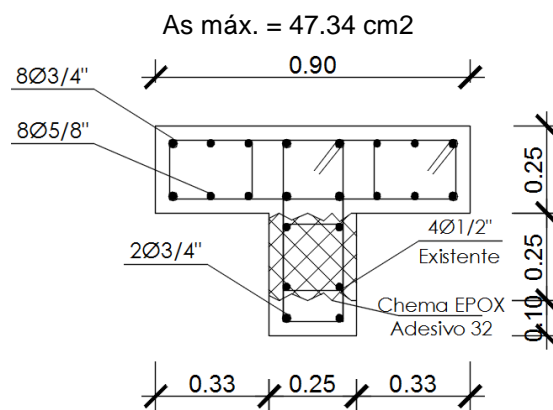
Refuerzo de columna de 25x25 a sección "T".
